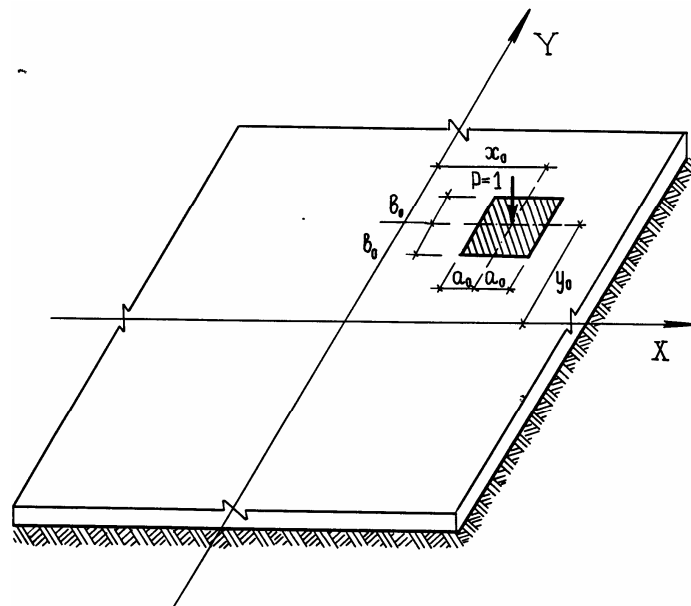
Расчетная схема бесконечной плиты, лежащей на упругом основании и нагруженной произвольной нагрузкой
